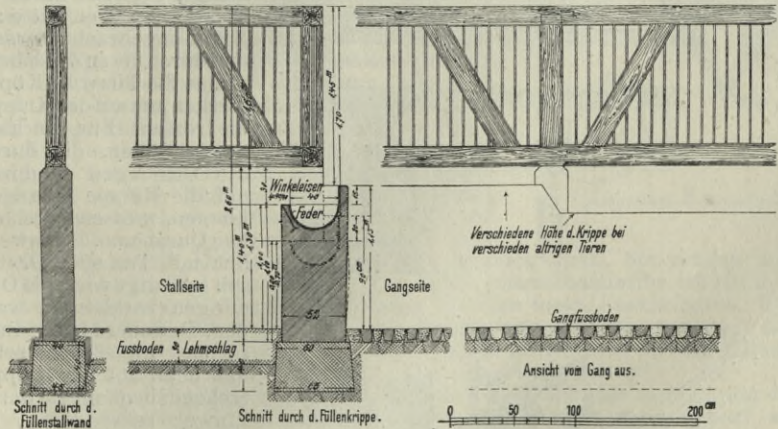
666. Wand und Krippe mit Untermauerung im Füllenstall.
